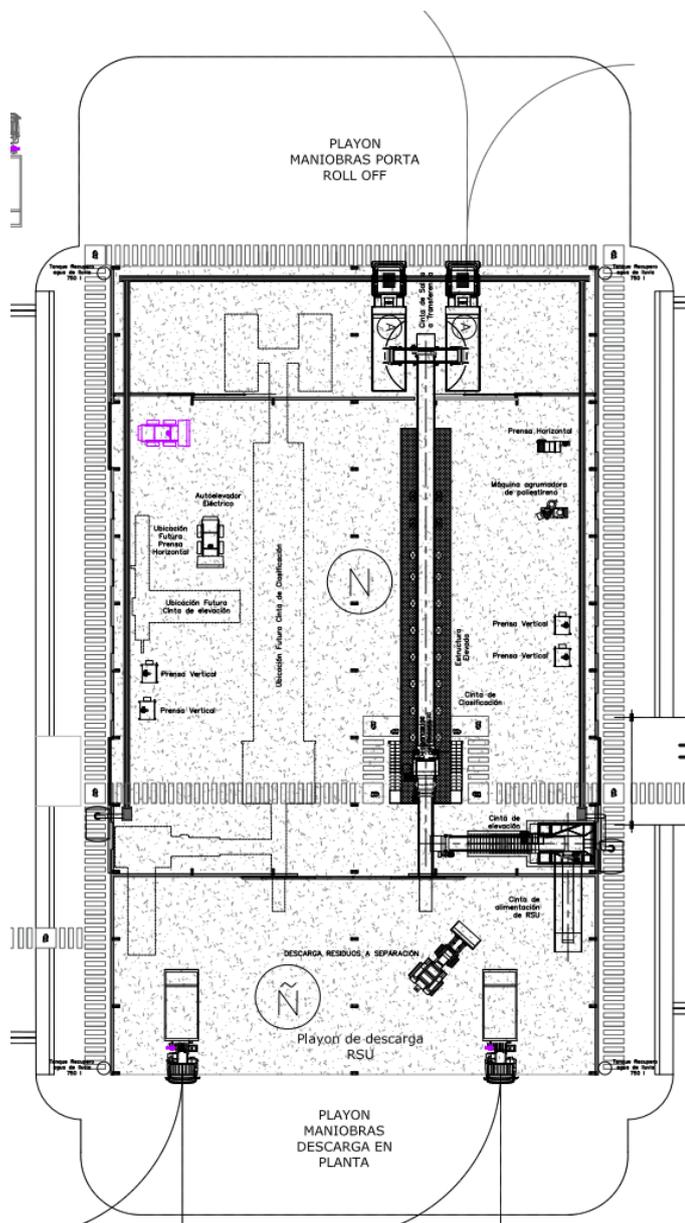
Lay Out Planta de Clasificación del Centro Ambiental Santiago del Estero – La Banda.
